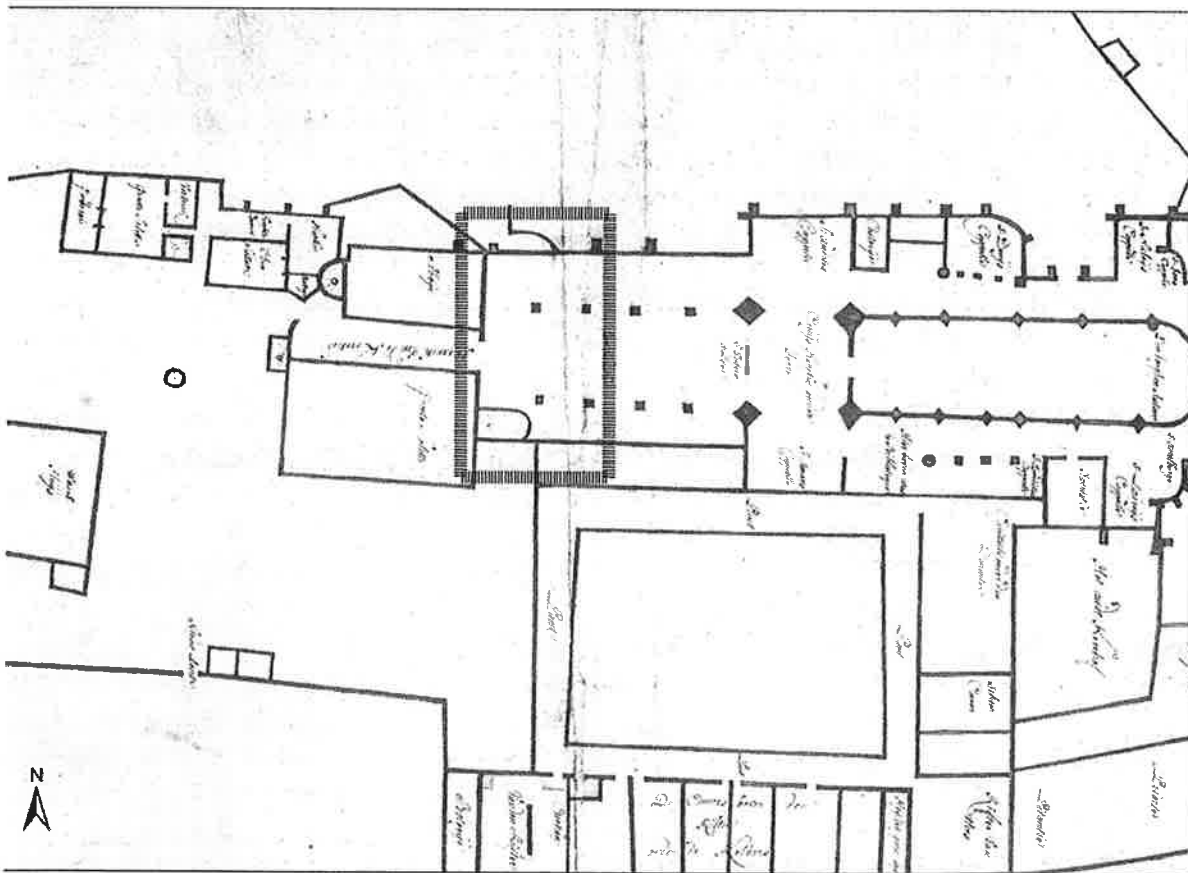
Rode plan (Rijksarchief Gent) met aanduiding van de onderzochte zone.
